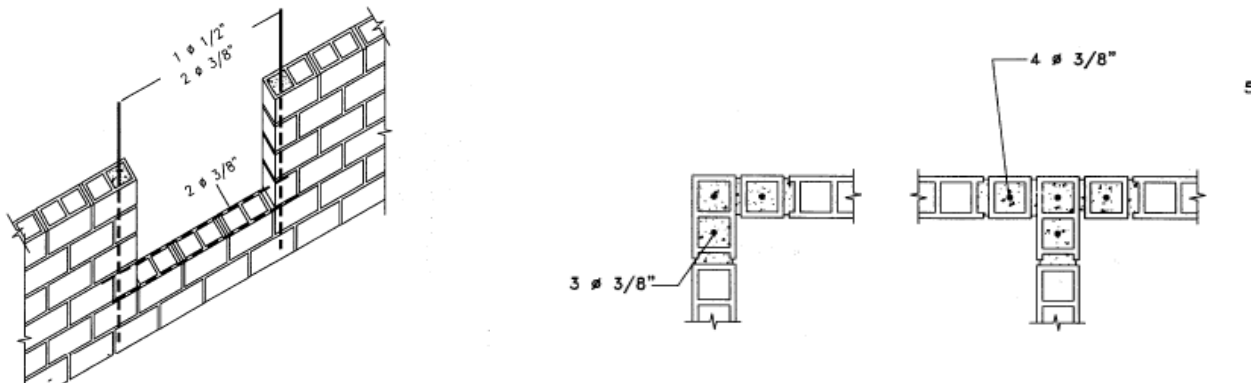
Detalles refuerzo vertical en ventanas e intersección de muros Edificios Banco Ademi
